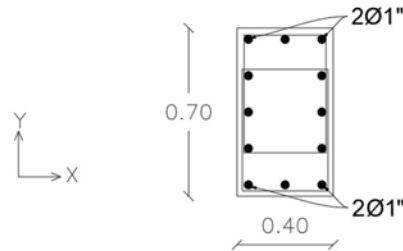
Armado tentativo de refuerzo en columna C-1
